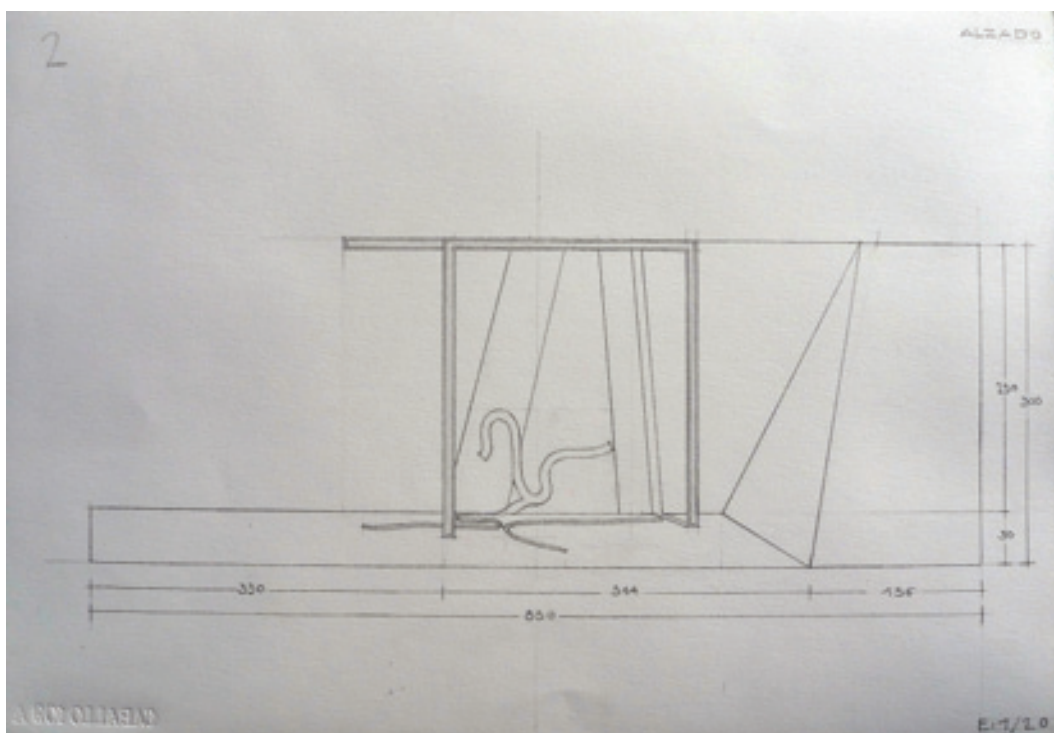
Planos 2. Alzado a escala 1/20. Dibujo. Papel, grafito. 52 x 34 cm.
